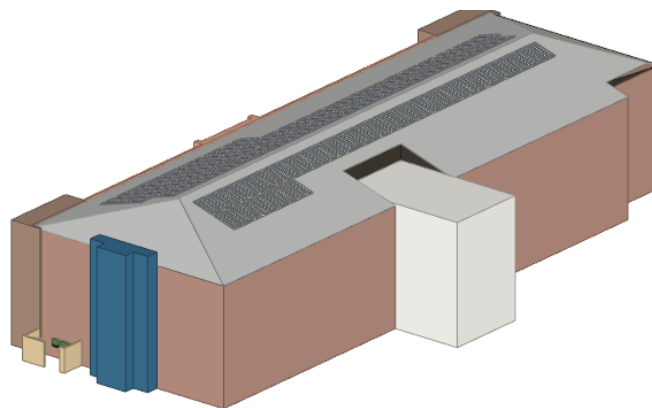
Vista izquierda de estructura de montaje de módulos
